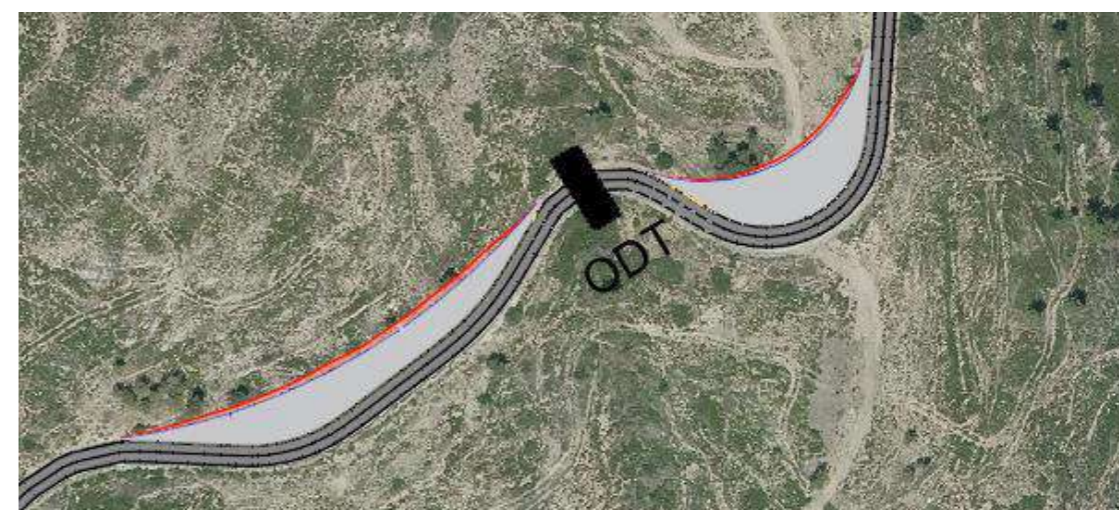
Zona donde se mejora el drenaje longitudinal y transversal con la disposición de varios despejes Fuente: Elaboración propia
